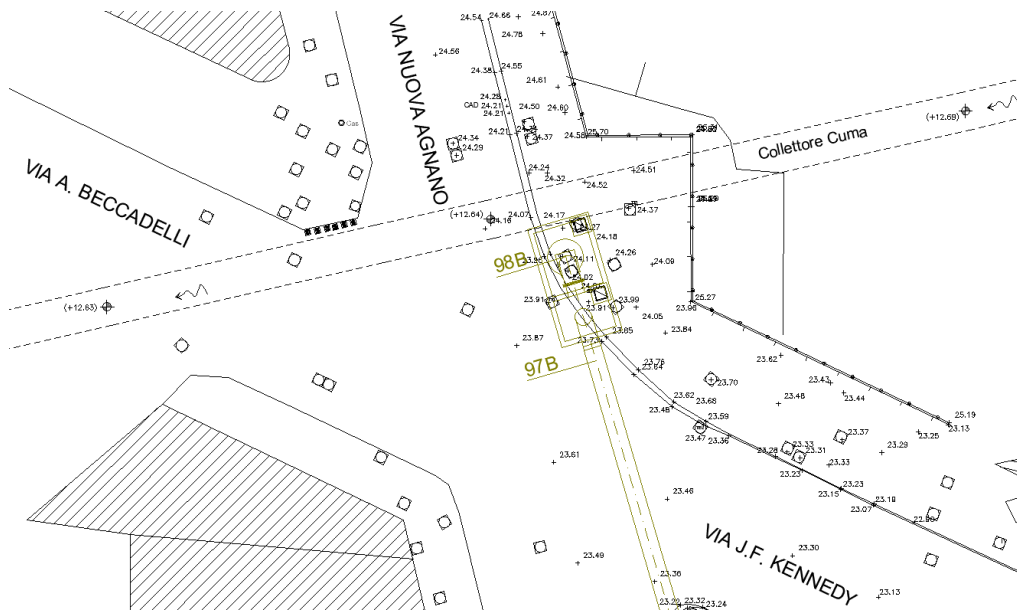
Immissione della premente B nel "pozzo 8" – Stralcio planimetrico
